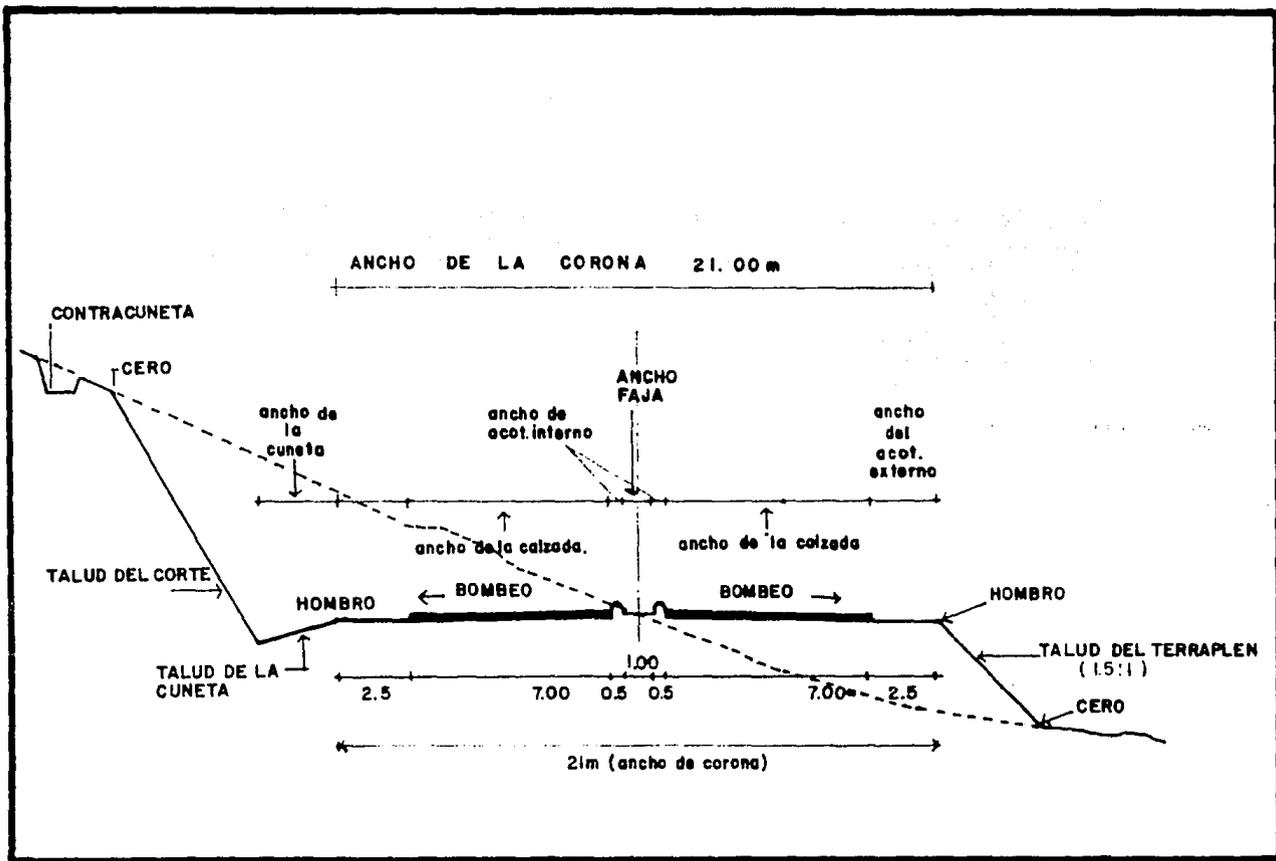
SECCION TIPO DE CARRETERA EN ZONA DE ACCESO A TUNEL.
